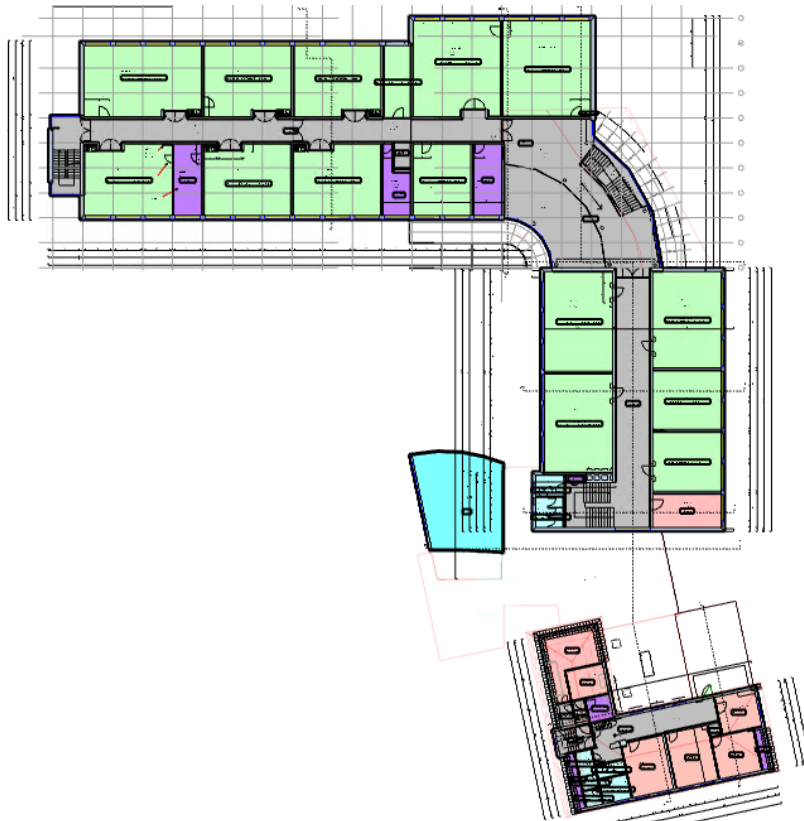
Grundriss OG 1, zониert (Cafeteria lediglich eingeschossig, Zonierung aufgrund Deckenhöhe)
